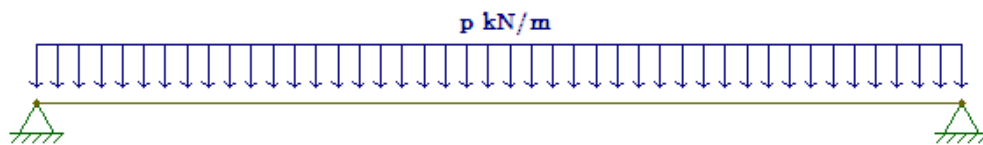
Viga Simplesmente apoiada com carga uniformemente distribuída.
